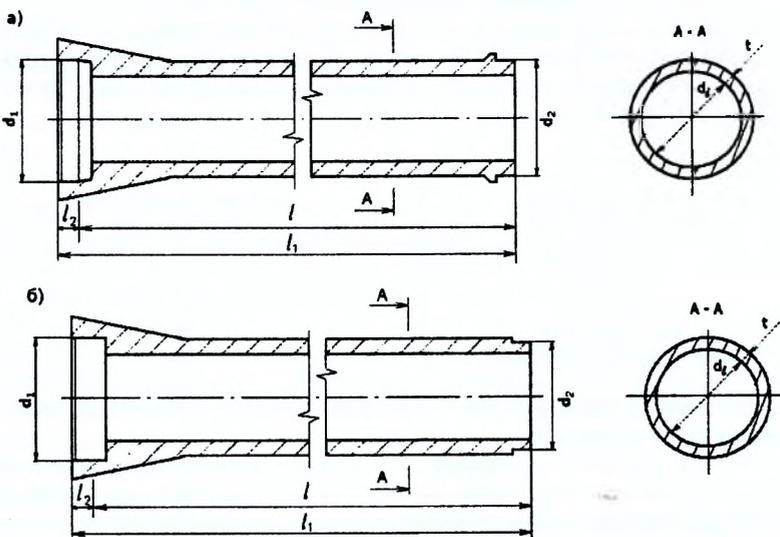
Общий вид труб типа ТБ (БТБ) – железобетонных (бетонных) цилиндрических раструбных с упорным буртиком или ступенчатой поверхностью втулочного конца трубы: а) с упорным буртиком на втулочном конце трубы, б) со ступенчатой поверхностью втулочного конца
